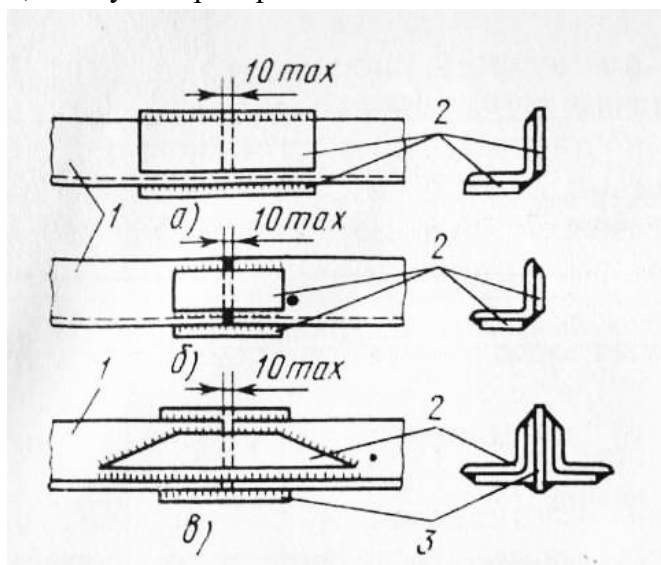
Стыковые соединения угловой стали: а — стык, перекрытый листовыми накладками, б — комбинированный стык, в—стык, перекрытый уголками и листовой фасонкой; 1 — стыкуемые уголки, 2— стыковые накладки (уголки), 3 — прокладки.
